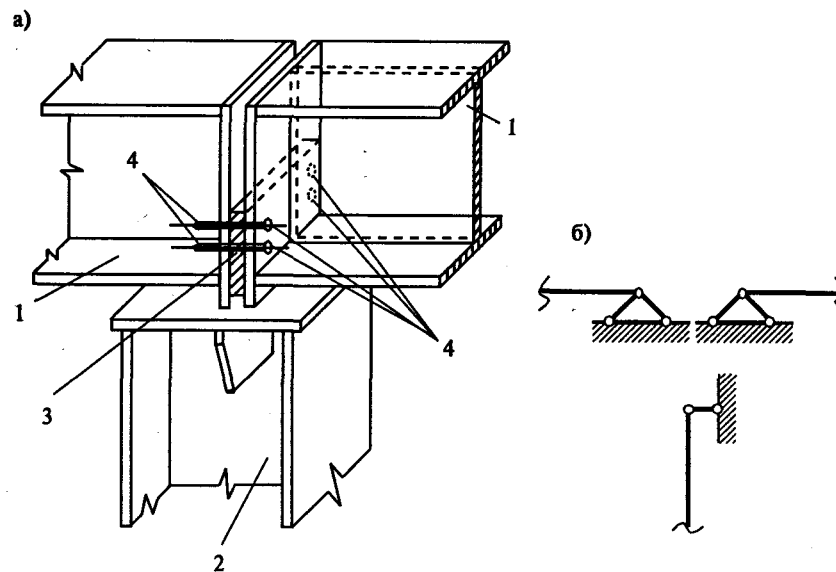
Шарнирное прикрепление балки к стальной колонне: а) схема опирания балок; б) расчетная схема опор для балок и колонны; 1 — балки; 2 — колонна; 3 — стальная прокладка; 4 — болты (гайка и головка болта не показаны)
